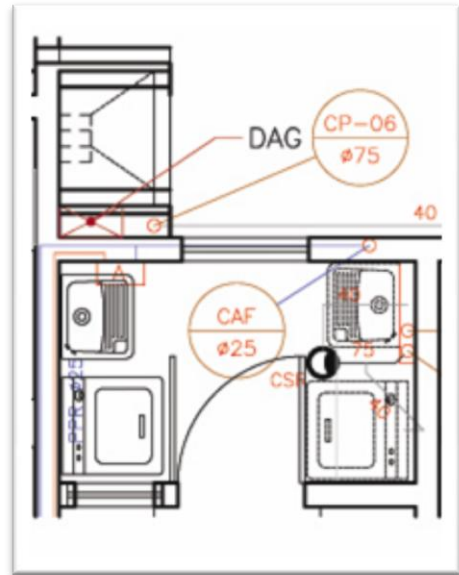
Planta baixa detalhe desalinhamento dos aparelhos.
